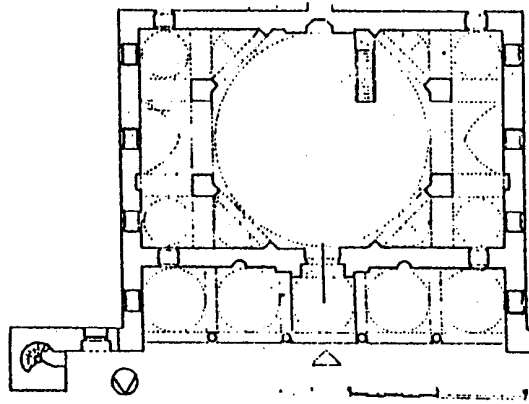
مسقط أفقي لجامع الخاتونية في مغنيسه (ما نيسا)
